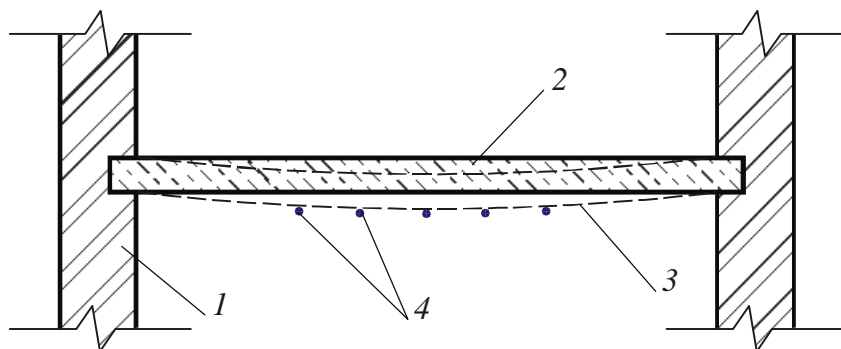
Устранение прогиба железобетонного перекрытия в середине пролета:
